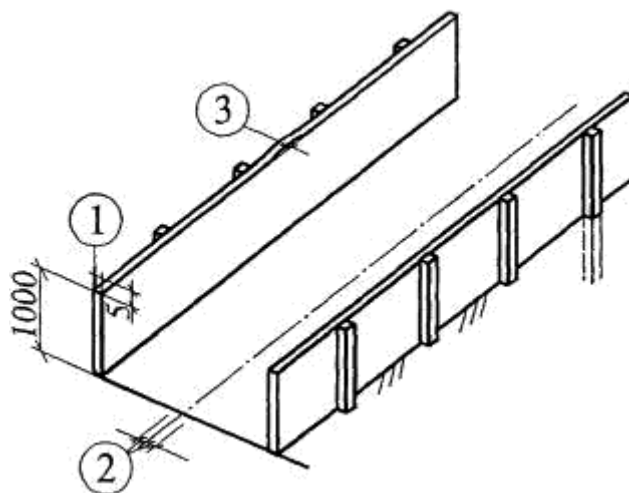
Предельные отклонения при установке опалубки плитных фундаментов
